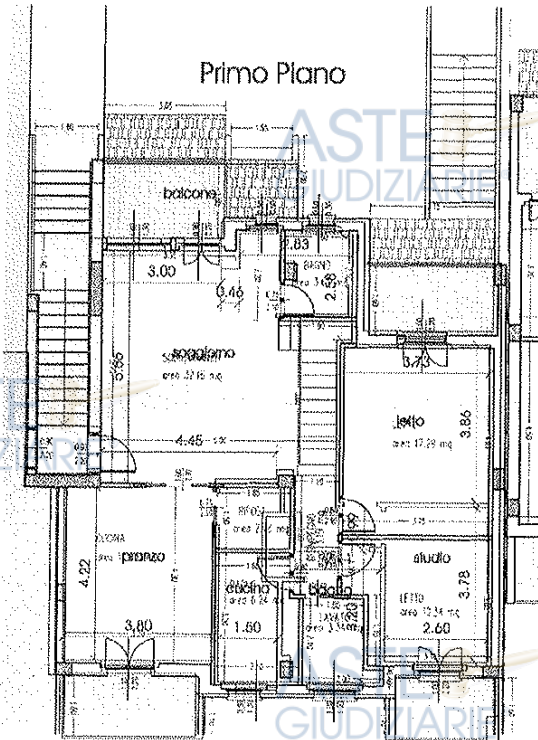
Primo Piano - sovrapposizione stato attuale con i disegni della Concessione edilizia
